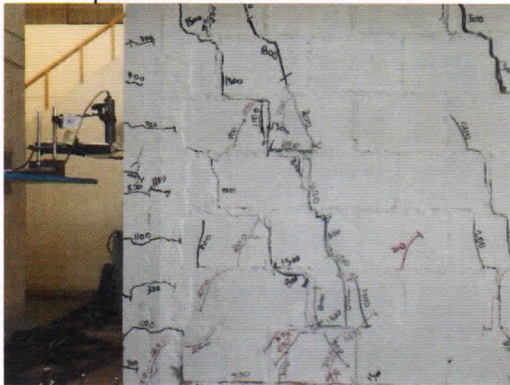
Formación de grietas diagonales en la parte Oeste de la cara Sur para una distorsión de 1/200.
